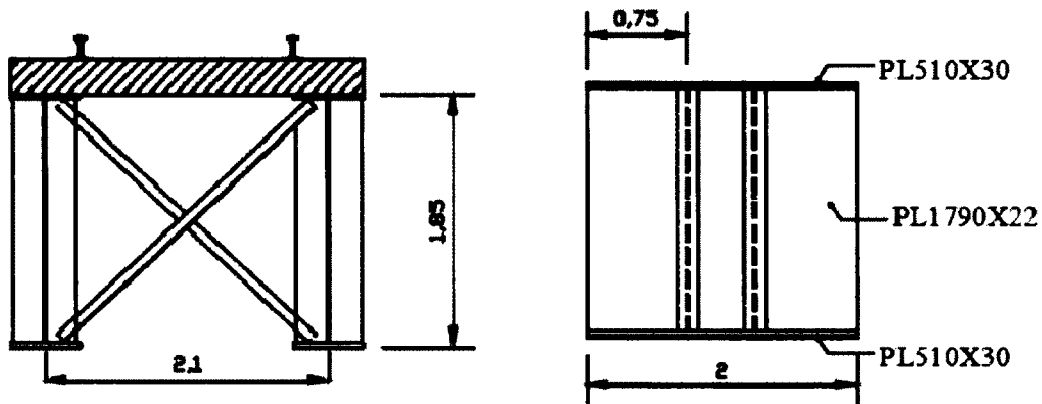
Pont bi-poutres - Section transversale et élévation - Section G-2
